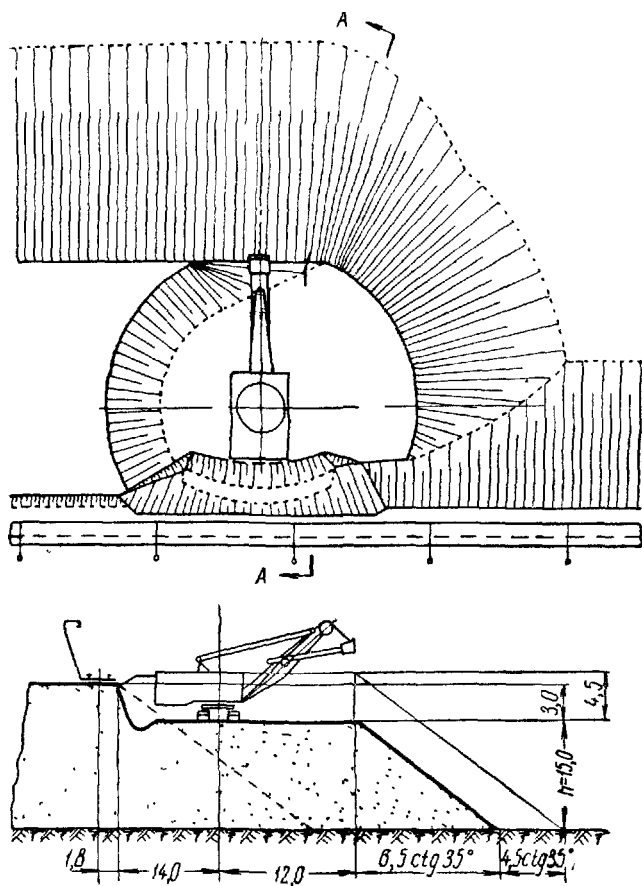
Схема экскаваторного отвала с одноковшовым экскаватором
